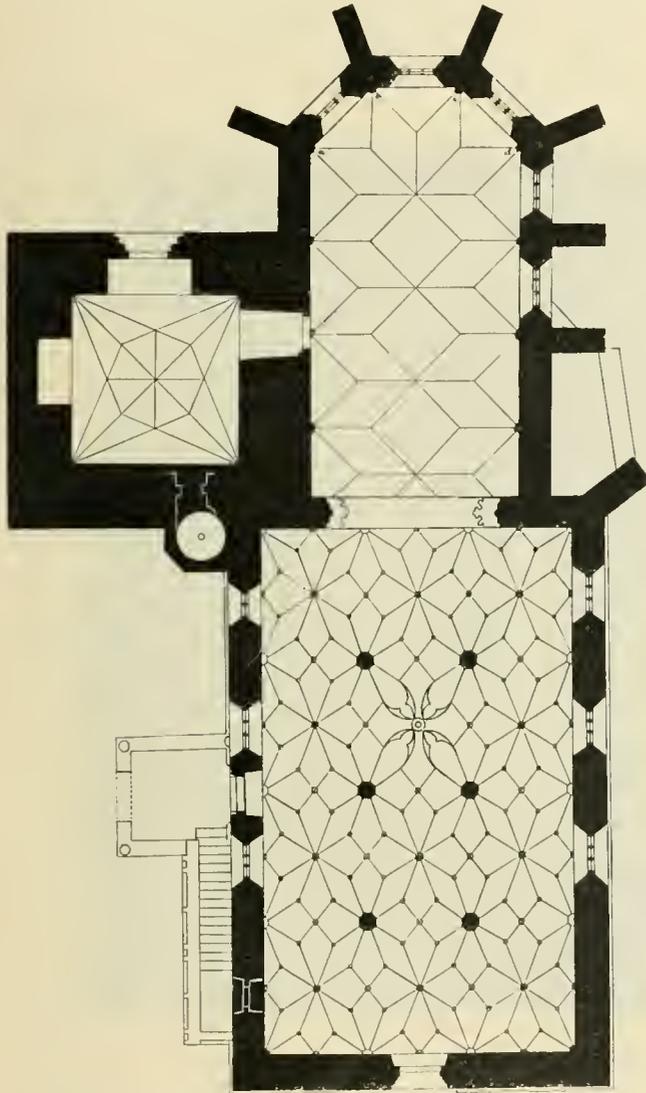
(St. Ruprecht in Unterkrain, Grundriß.)
